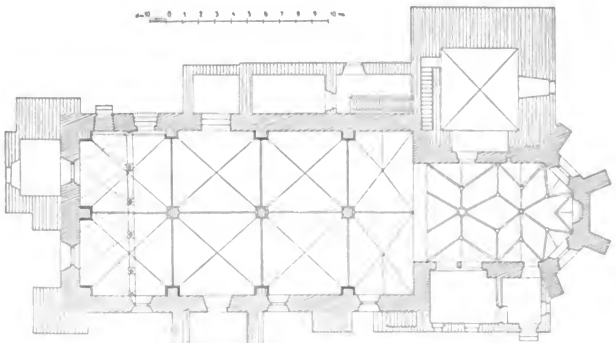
Bechin. Grundriss der Decanalkirche.
